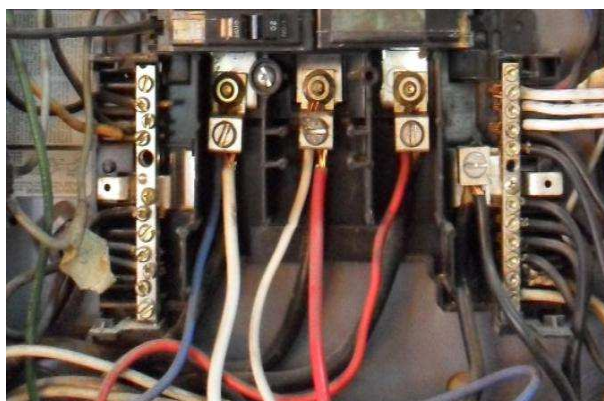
Conductores conectados a las zapatas principales del tablero 1B.
